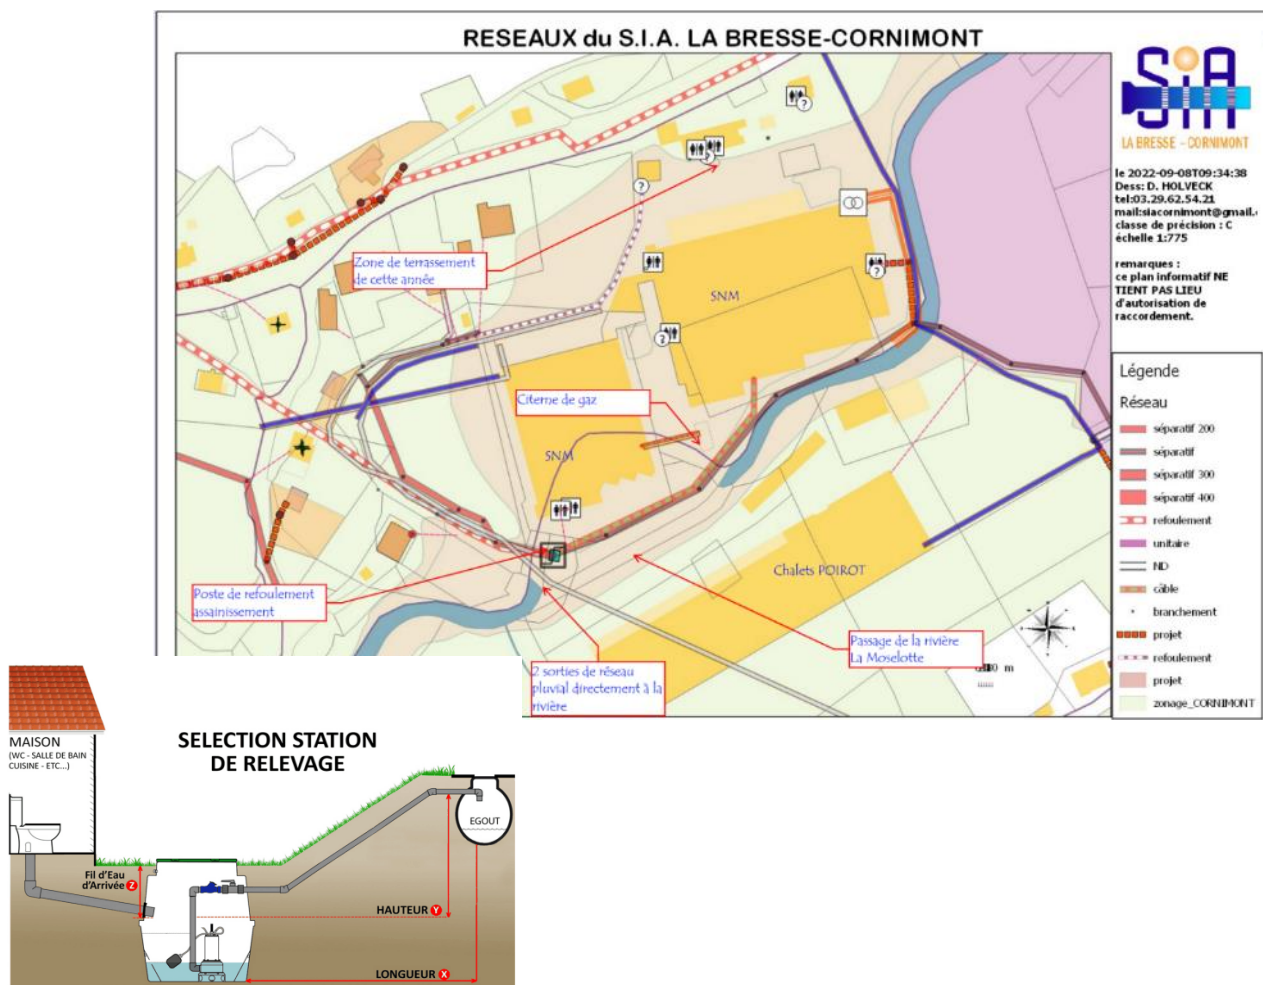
Plan des réseaux d'assainissement sur la zone d'investigation (source : SIA La Bresse – Cornimont) et schéma d'une station de relevage
